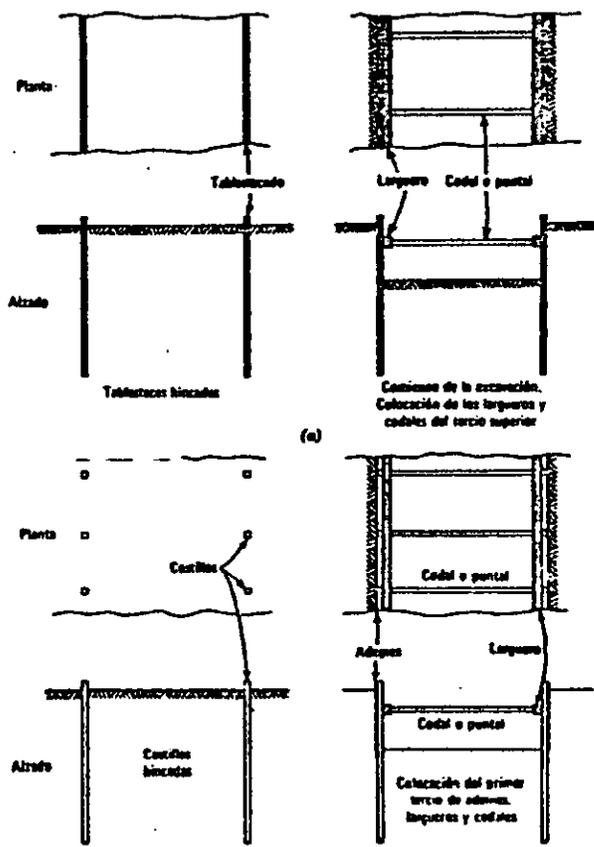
Métodos de colocación de apuntalamiento. a) Excavación apuntalada mediante tablestacas. b) Excavación apuntalada mediante costillas y ademes
